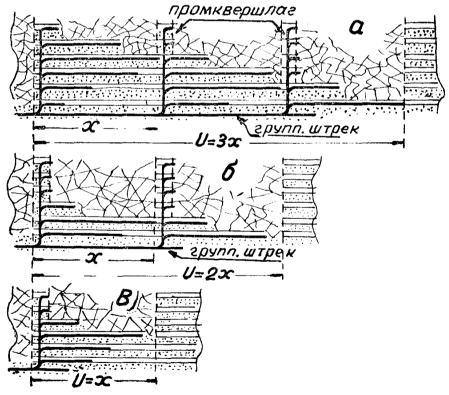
Принципиальная схема развития горных работ на крыле этажа (план выработок)
